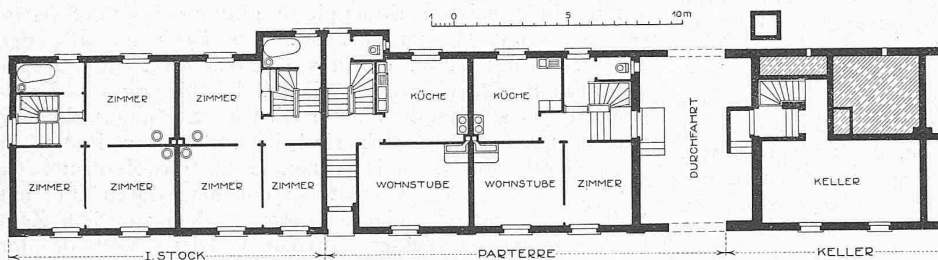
und 14. Grundrisse 1:300 und Gesamtbild der Angestellten-Häuser Steiners Söhne in Malzers.
